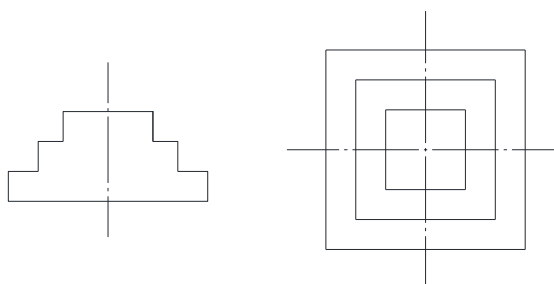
Отдельно-стоящий фундамент под колонну
